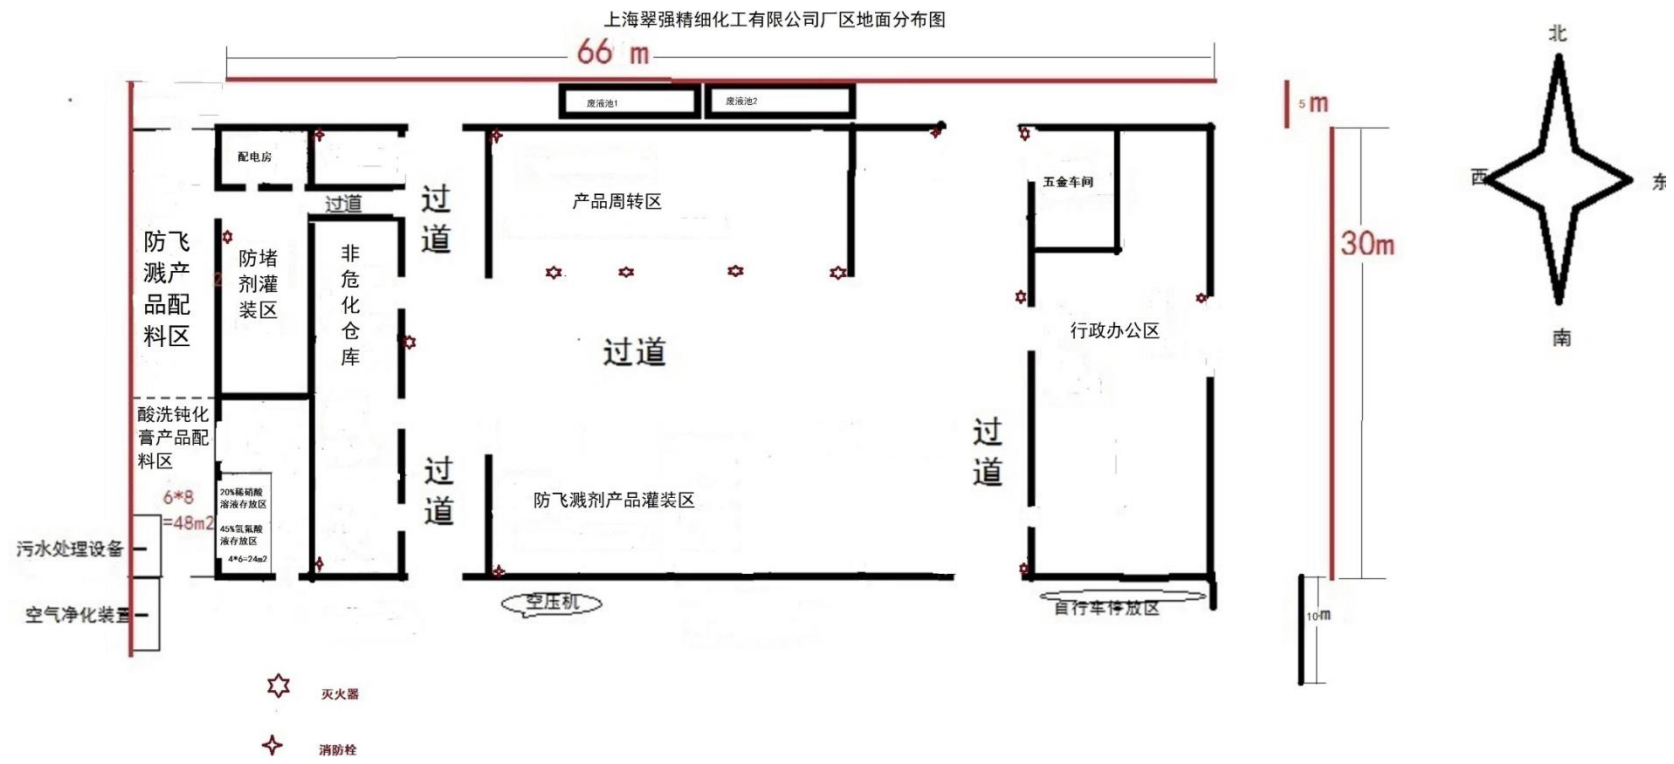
上海翠强精细化工有限公司生产车间平面布置图
